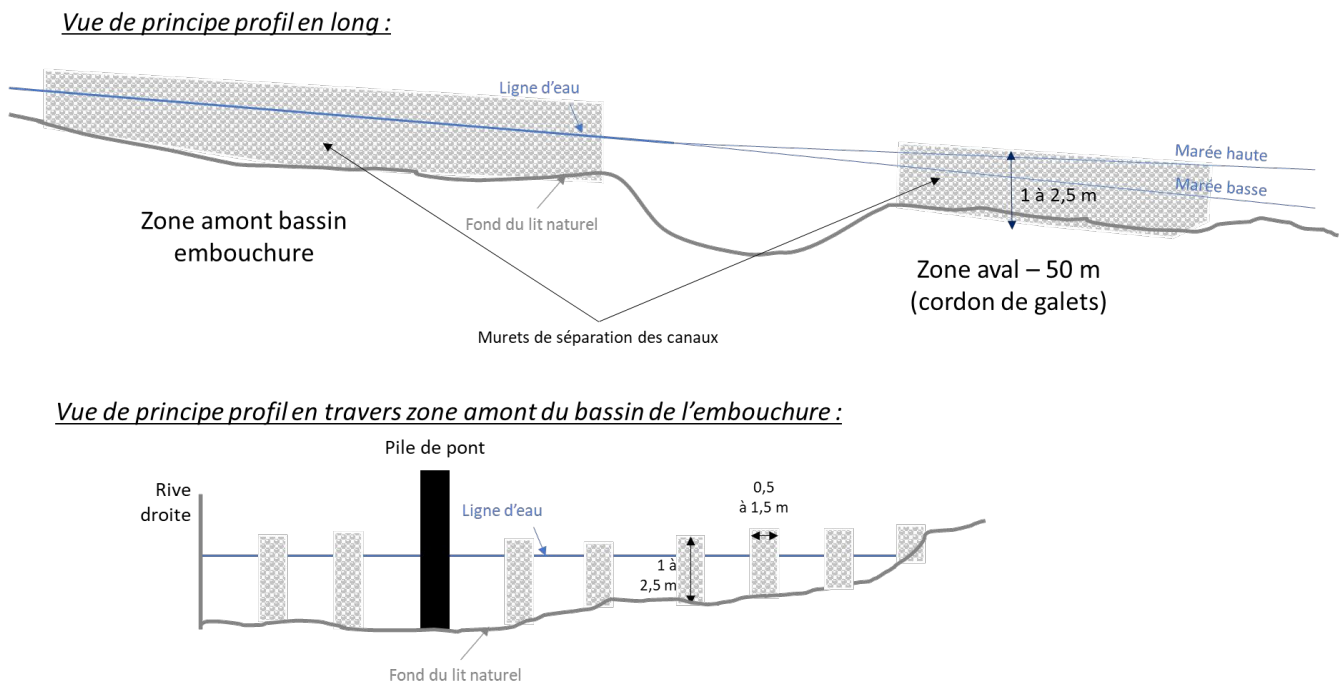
Schéma de principe des canaux entretenus par l'APRSD : vue du profil en long des deux rangs de canaux et du profil en travers au second rang.
